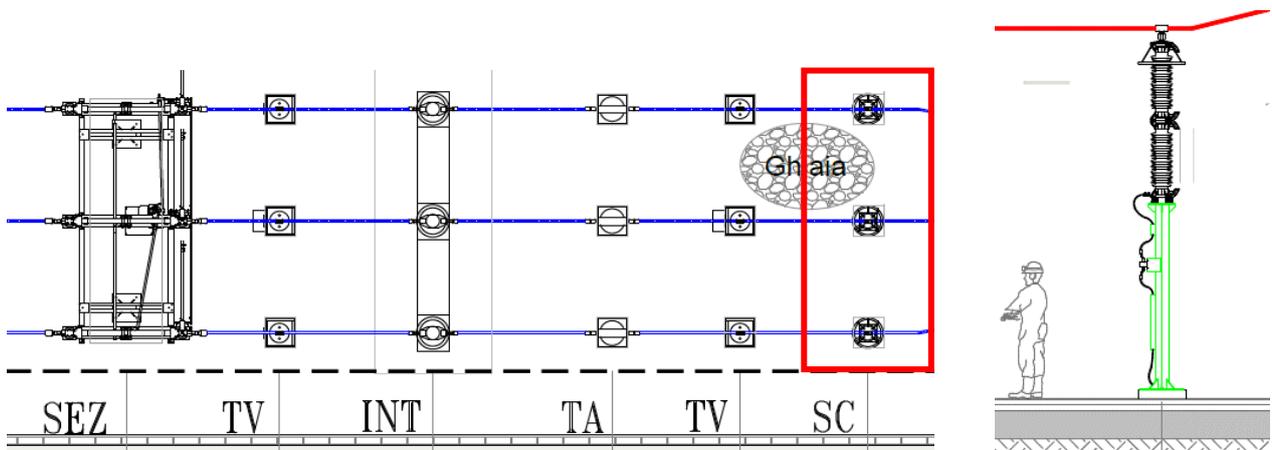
Tipico scaricatore di sovratensione – vista prospettica e planimetrica
